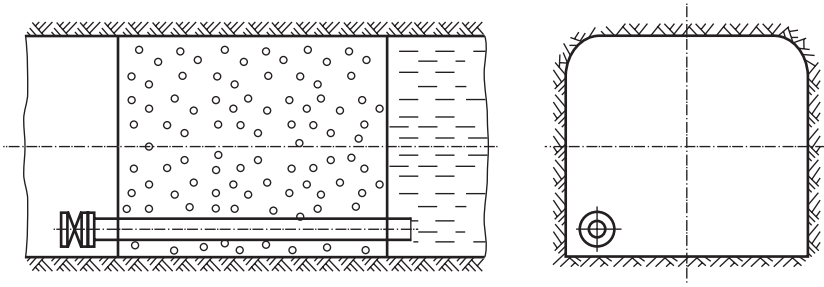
Безрубчатая прямоугольная водонепроницаемая перемычка
